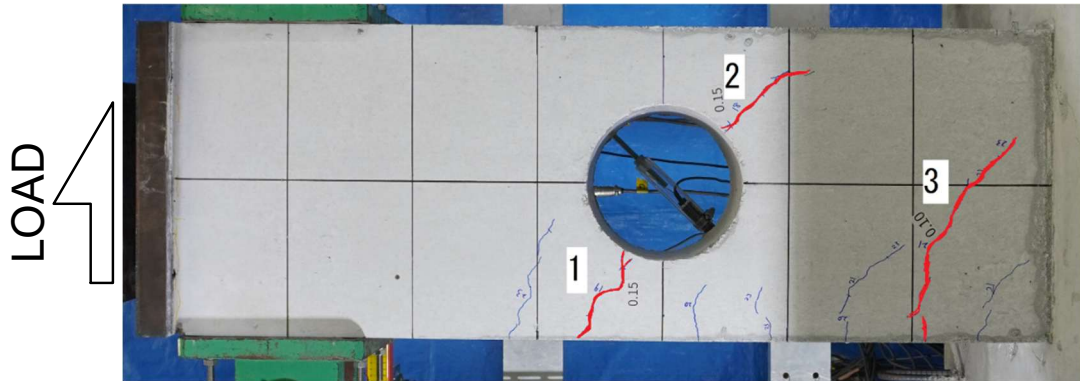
貫通孔周囲のひび割れ位置
